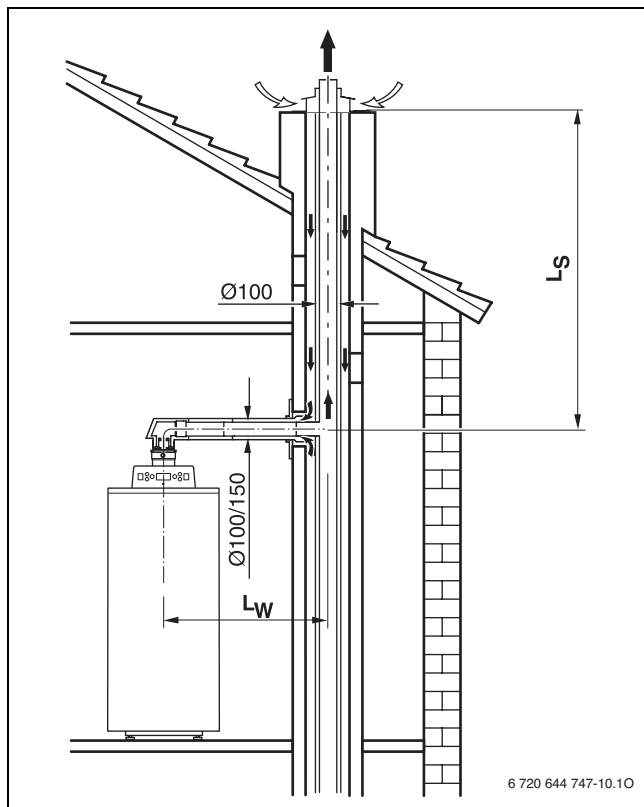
Doppelrohrführung bis zum bestehenden Abgasschacht ($C_{43(x)}$)
